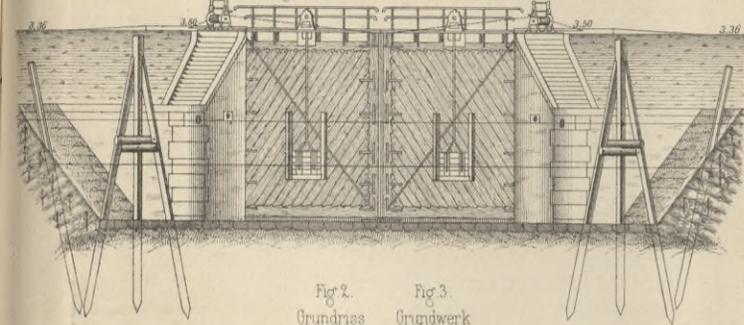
Grundriss des Aussenhauptes. Fig. 3. Grundwerk des Aussenhauptes.
